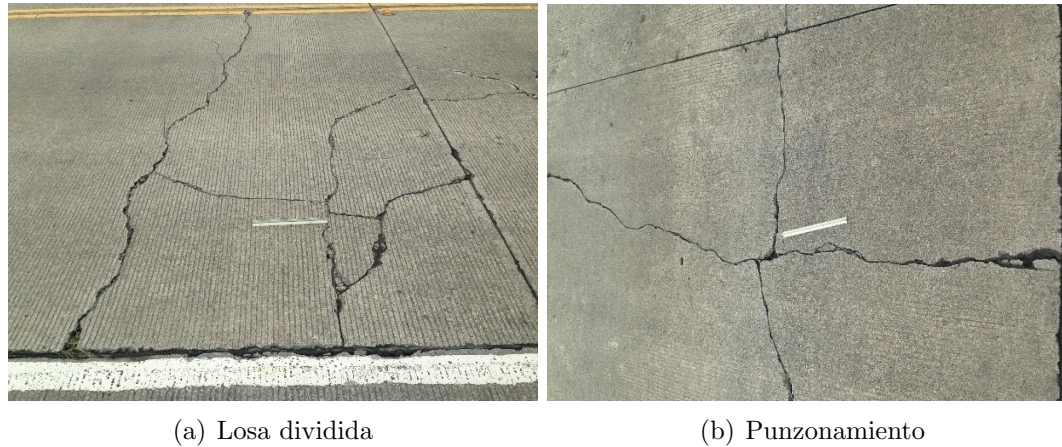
Losa dividida y punzonamiento presentes en el pavimento rígido.
